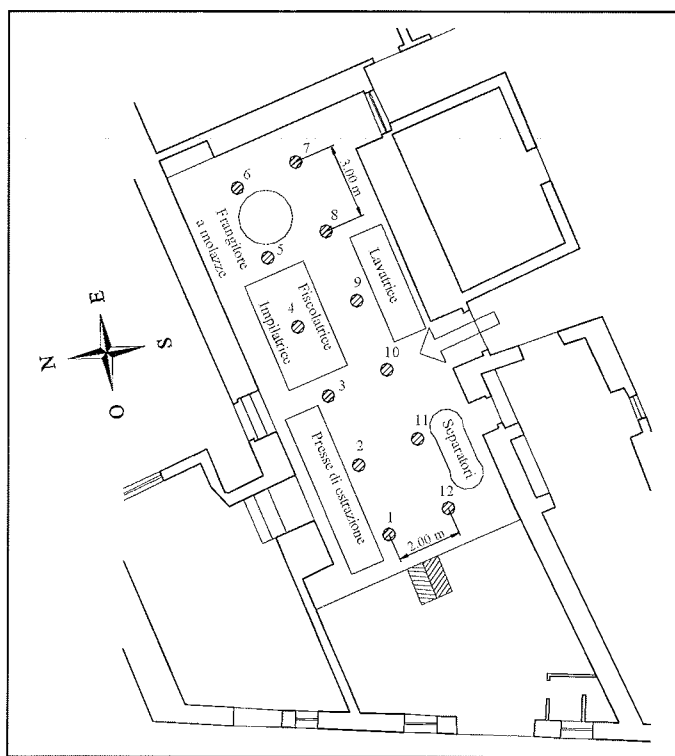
Planimetria frantoio discontinuo “E”, con l’indicazione dei punti di posizionamento degli strumenti di misura.
